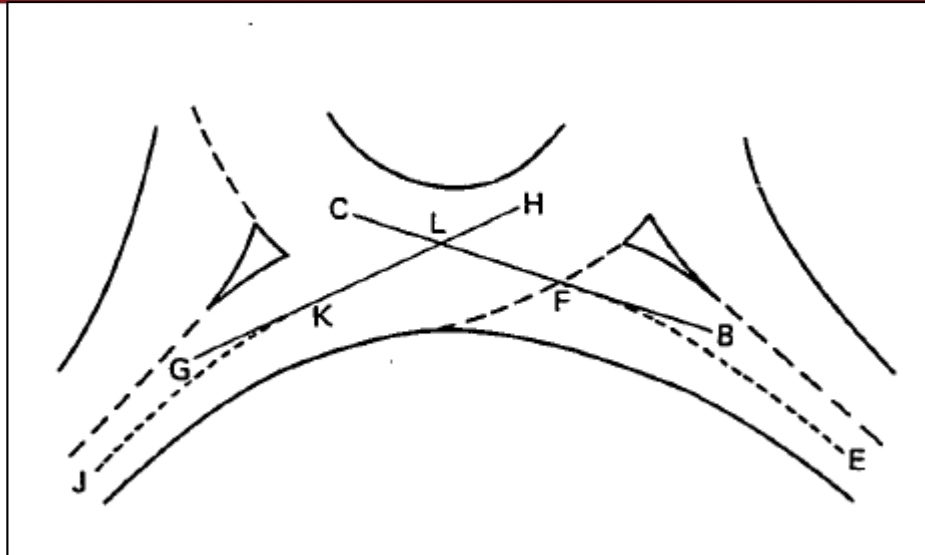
Ángulo de entrada a la rotonda. Fuente: Kimber, 1980
